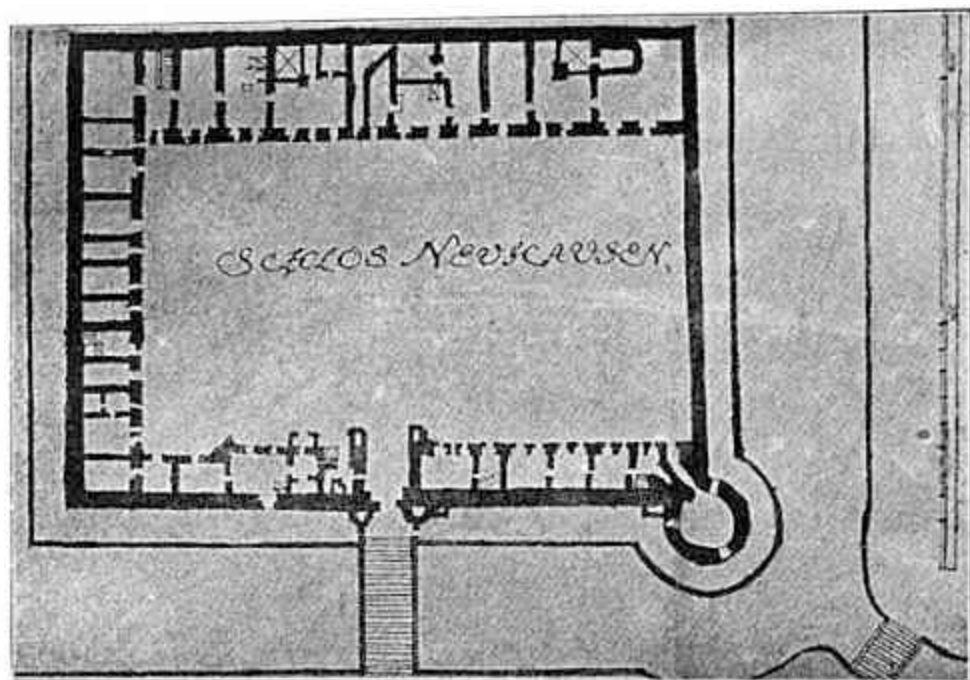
Grundriss der Burg Neuhausen (v. Collas).
